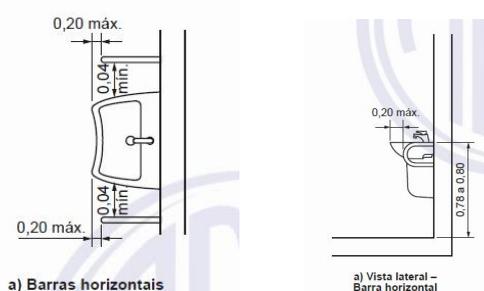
Barras de apoio lavatório (ABNT NBR 9050:2020).
